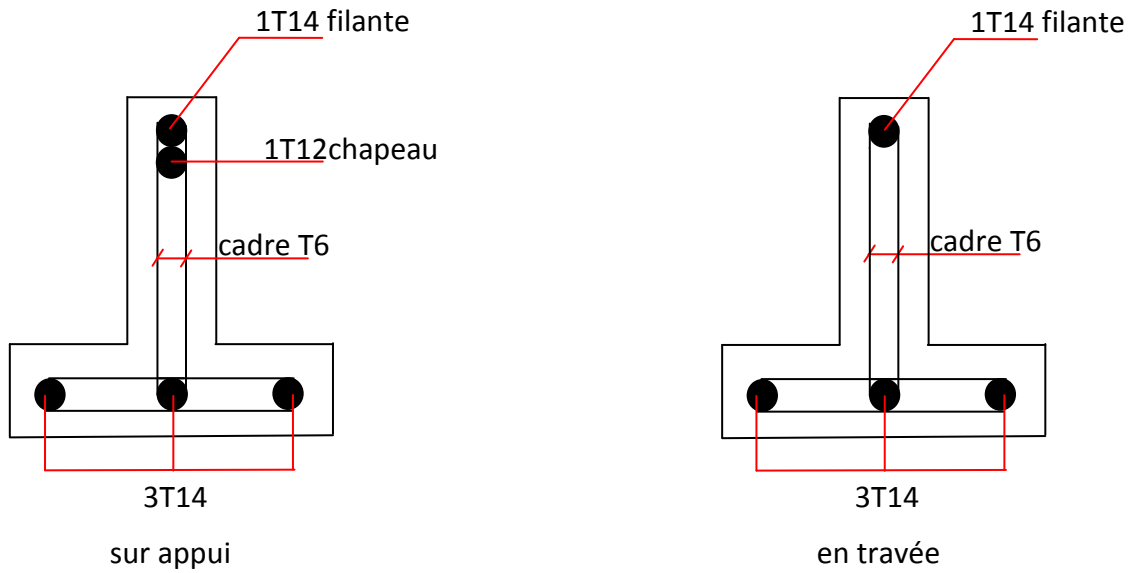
schéma de ferrailage des poutrelles du plancher sous- sol .
